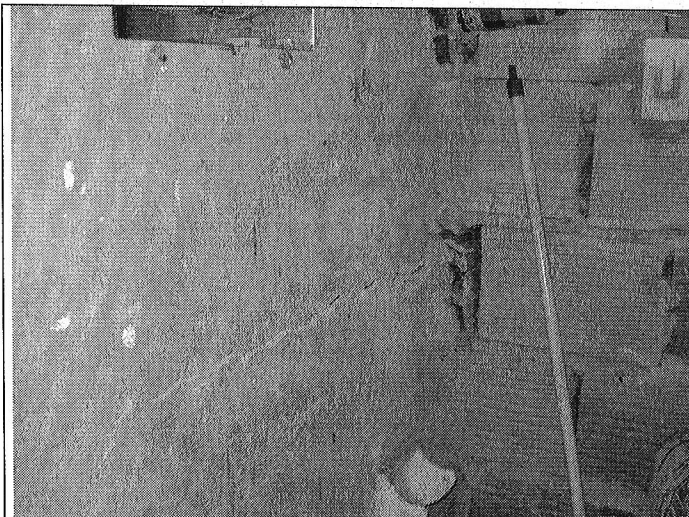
Fisura de 1 cm de ancho aproximadamente, presentada en muro divisorio del baño del lote 4 de la manzana 14 (Observar Figura 1)
